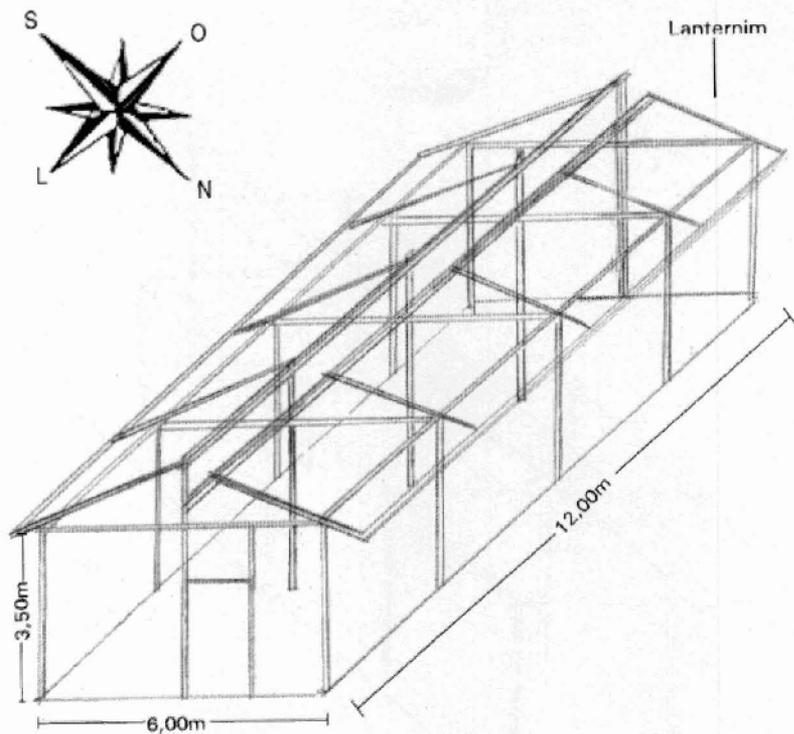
Estrutura do telado com cobertura plástica, tipo capela, com o teto em duas águas.
